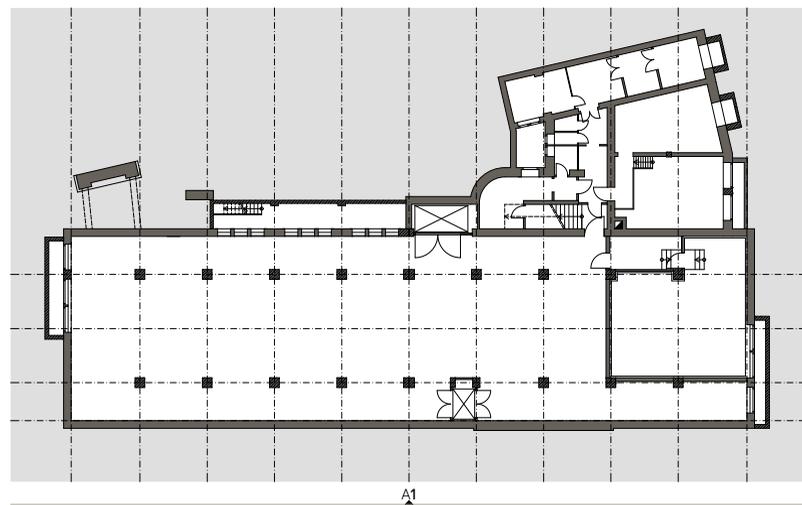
2. Obergeschoß, Hauptgeschoß
